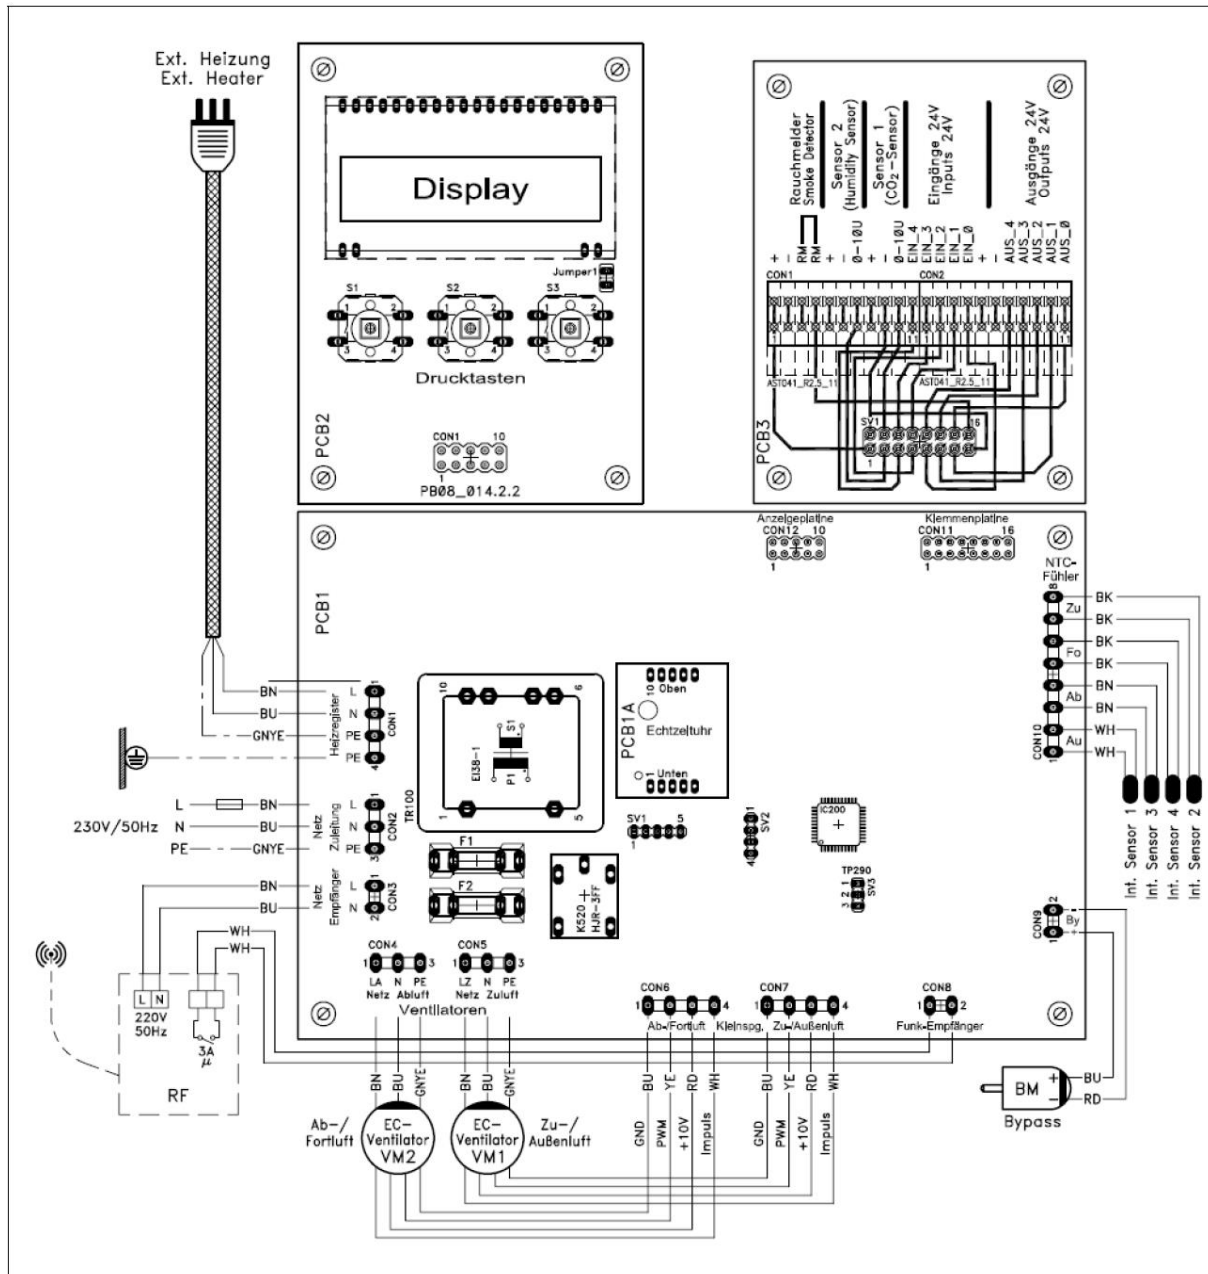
Płyta główna PCB1 z obwodem drukowanym zegara czasu rzeczywistego PCB1A
